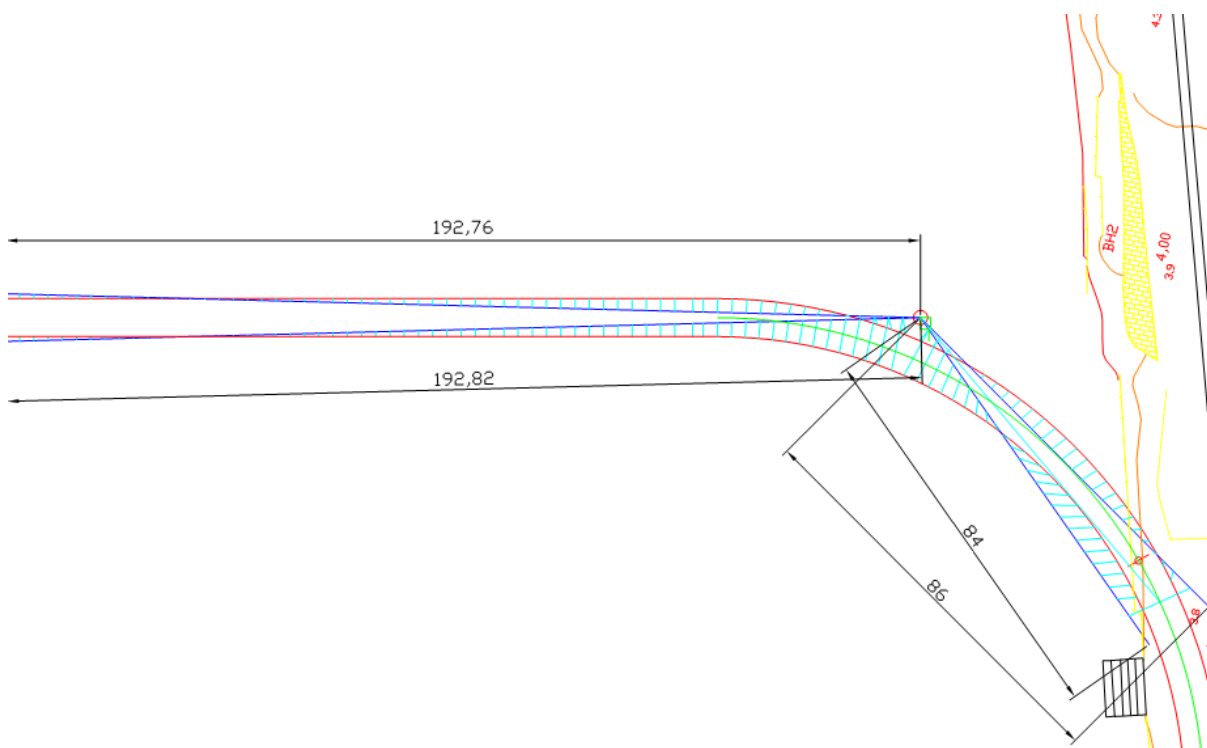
Planta inicial da geometria da ponte pedonal
